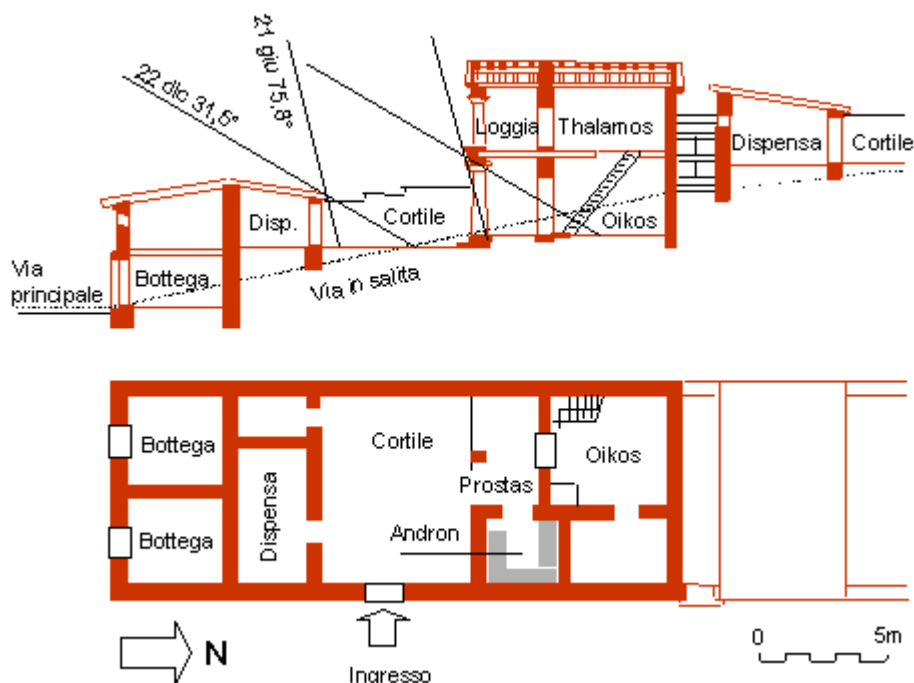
Pianta e sezione di una casa a "prosta" di Priene
